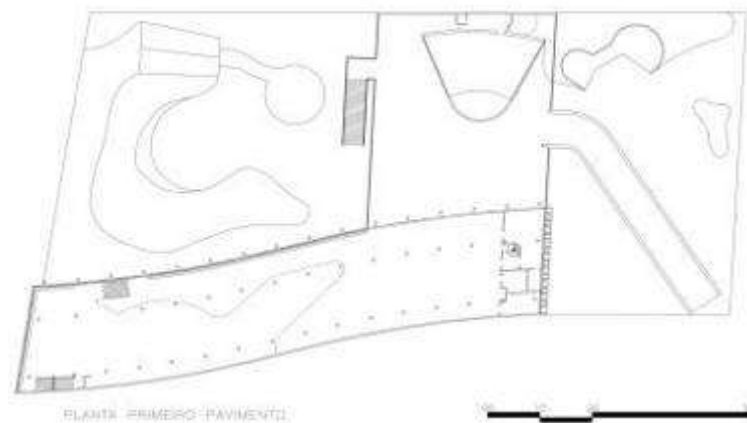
Redesenho a partir das plantas do projeto elétrico – 1º Pavimento. Fonte: do autor em parceria com Eduardo Verri Lopes, anteriormente publicado em (MACEDO, LOPES, 2009).
